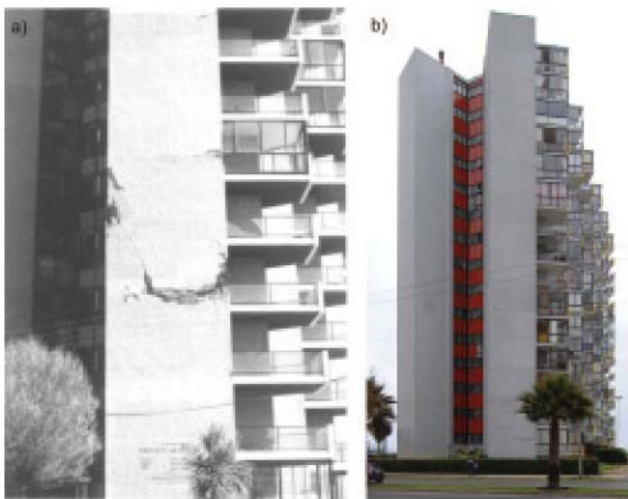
Gebäude Acapulco in Viña del Mar: Schäden an Stahlbeton-Aussenwand nach dem Erdbeben 1985 [WWM87] (a) und verstärkte, unbeschädigte Aussenwand nach dem Erdbeben 2010 (b).
